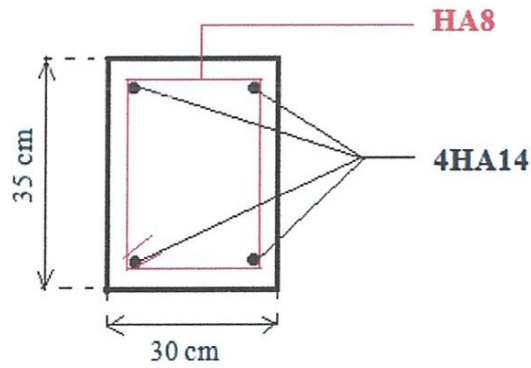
Dessin du ferrailage des poutres secondaires (chainages)
